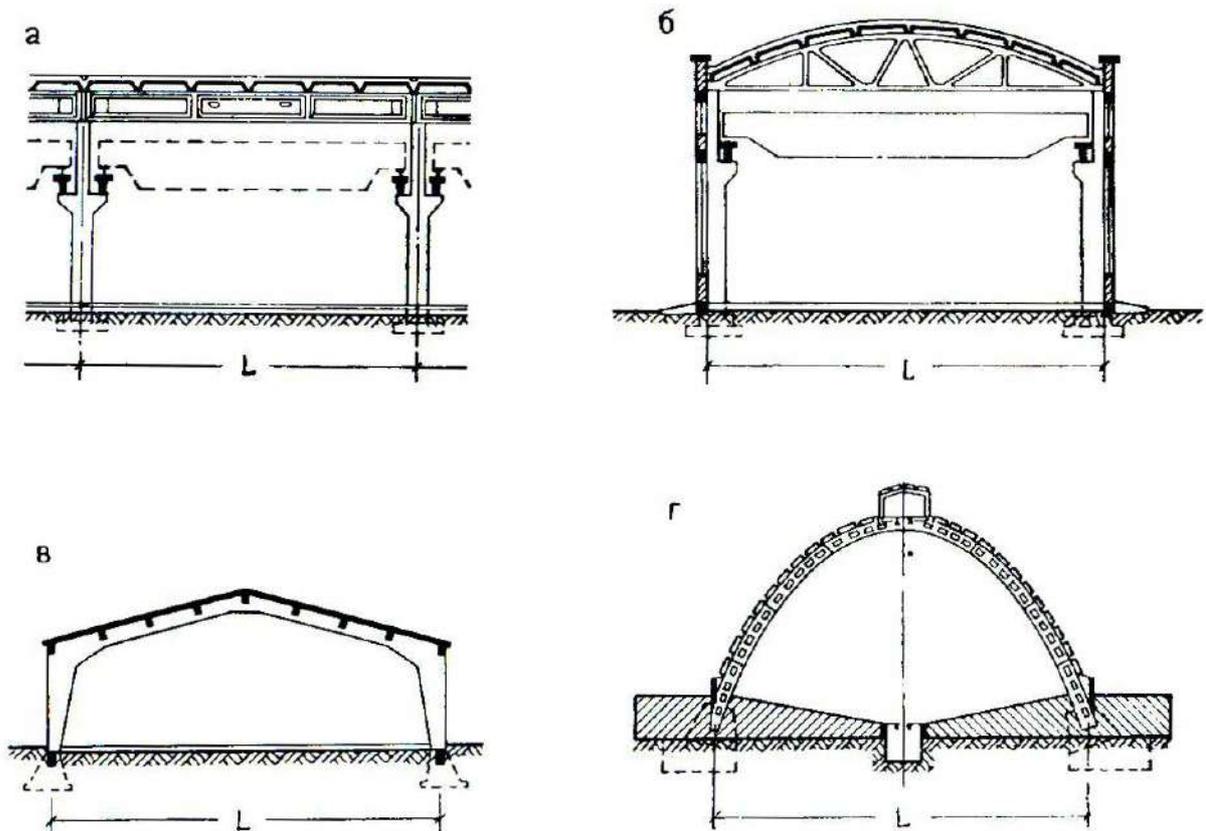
Конструктивные схемы покрытий каркасных промышленных зданий. Плоскостные системы покрытий:
